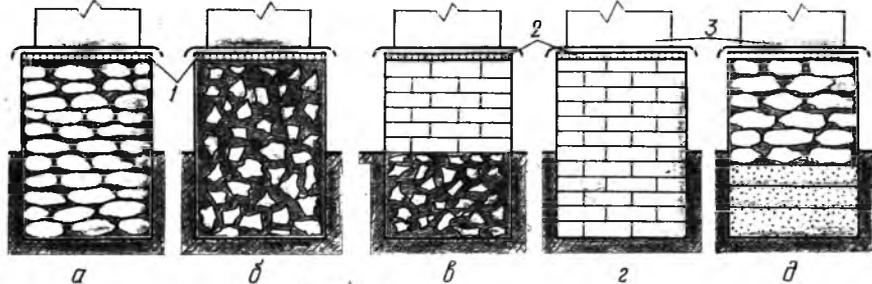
Столбы для фундаментов из различных материалов: а — бутовый; б — бутобетонный; в — кирпичный по бутобетону; г — кирпичный; д — бутобетонный на песчаной подушке; 1 — выравнивающий слой; 2 — гидроизоляционный слой; 3 — стена постройки
